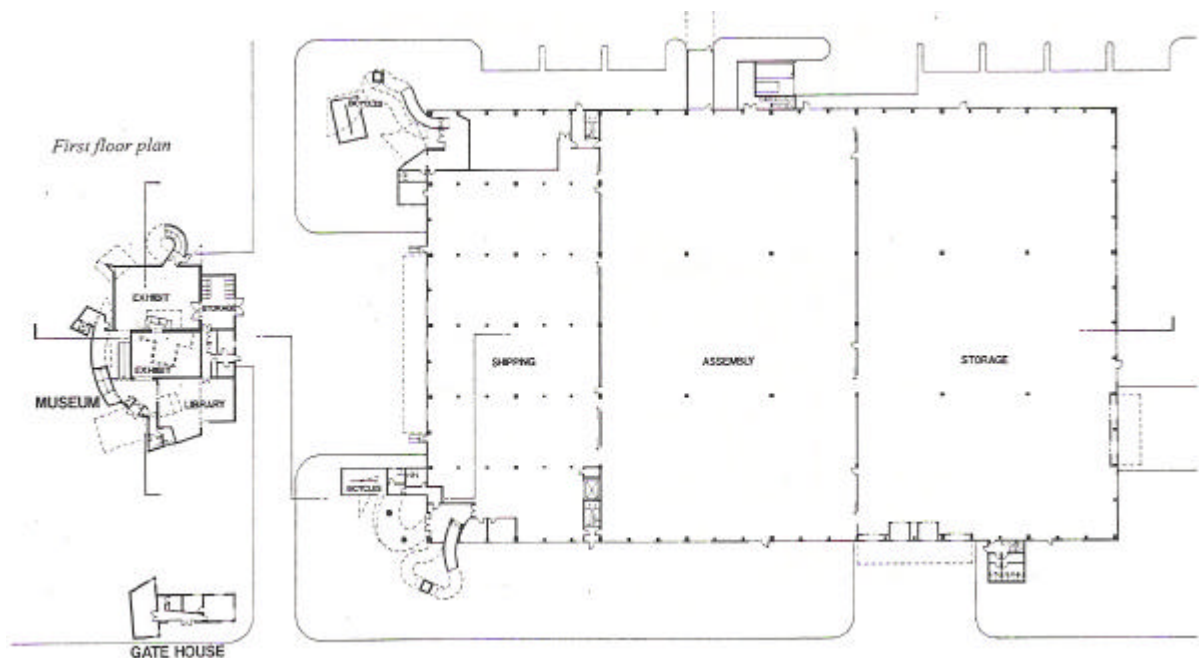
Frank Gehry, Fabrikationshalle, Museum und Pförtnerhaus, 1987-1989, Grundriß Erdgeschoss
